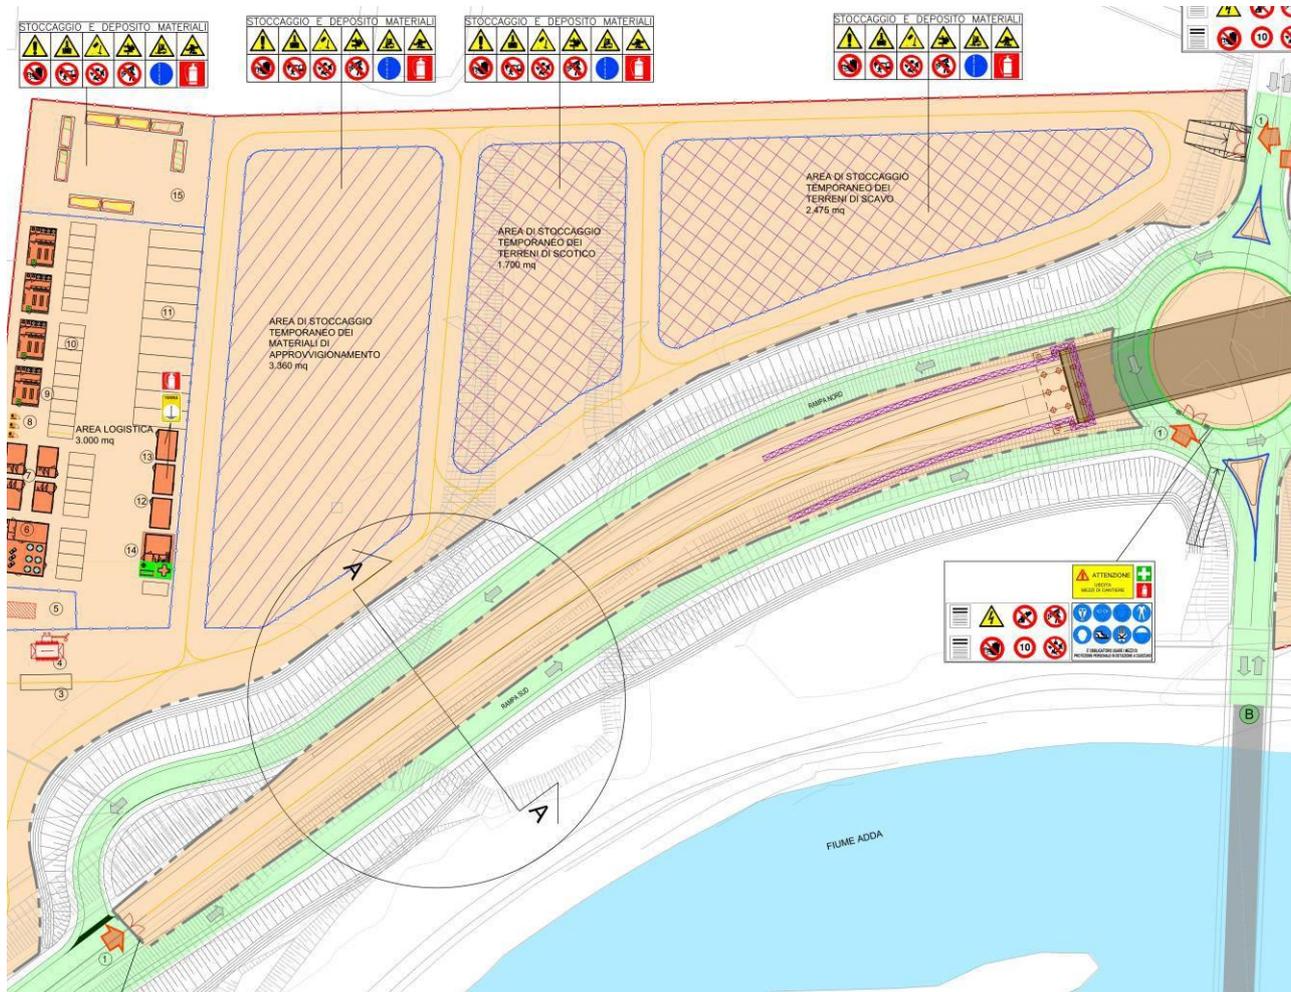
Realizzazione spalla A e muri di contenimento
